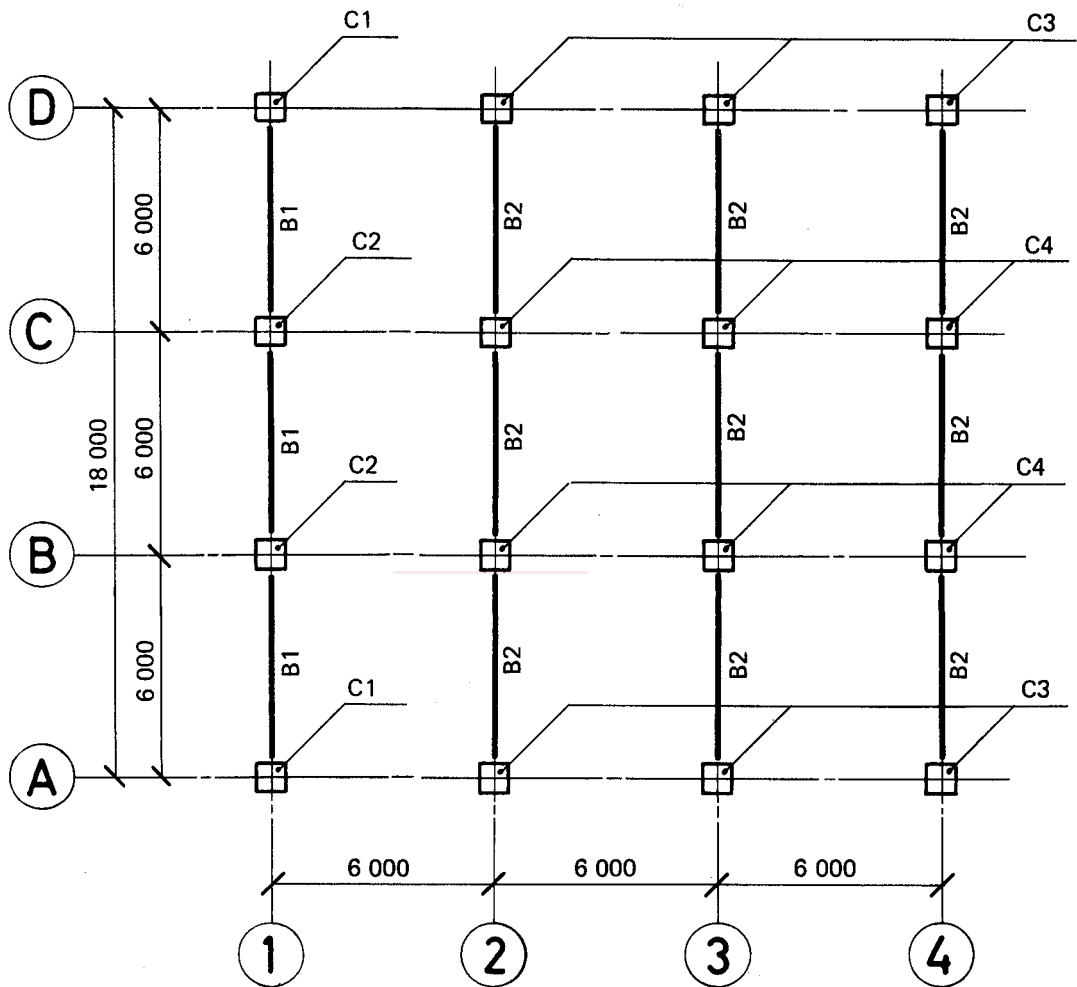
Exemple de dessin d'ensemble pour les composants d'un coffrage
